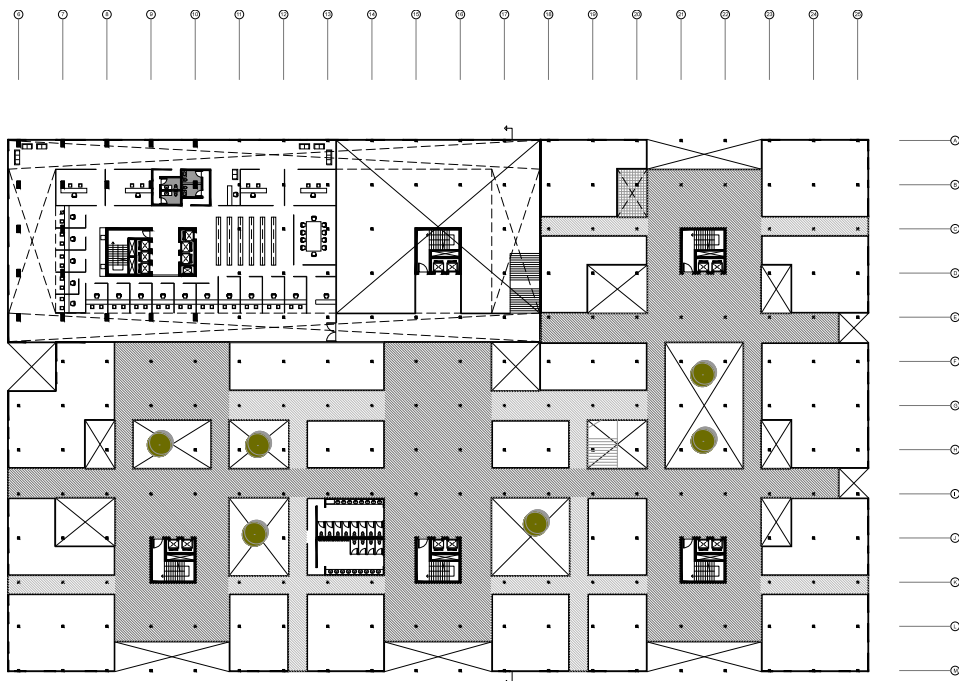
Planta N+/- 4.00 m (elaboración propia)
